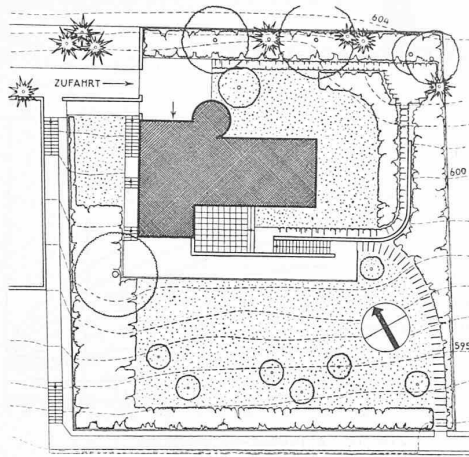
Haus B. Séquin. — Lageplan 1 : 600.
